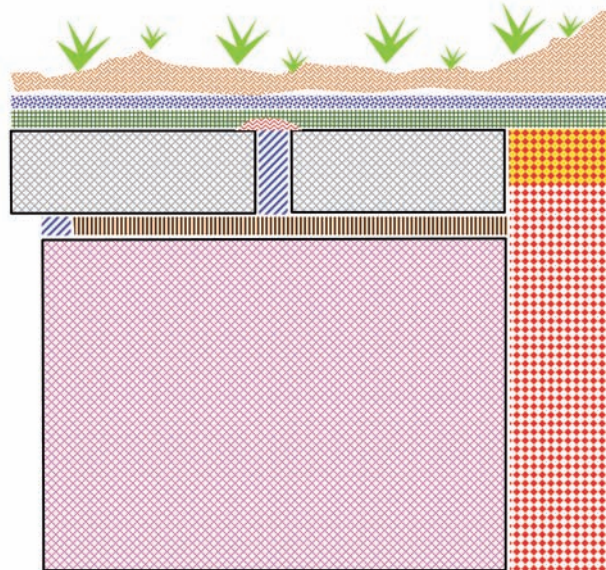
Esquema de tratamento da rocha-tipo, com representação da inertização do topo com terrenos locais, estabilizados com RB1 81, da Road Building International (opção a testar futuramente).
